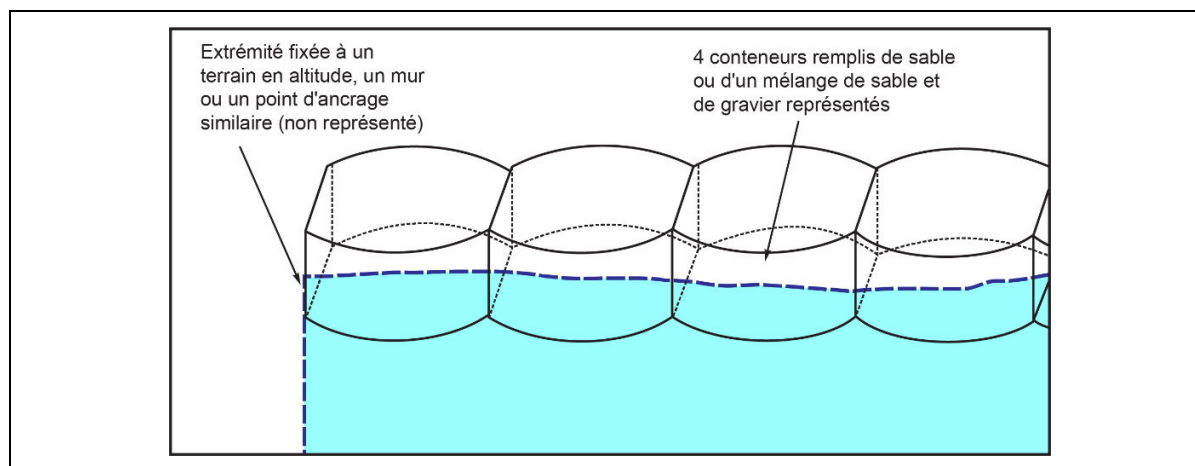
Conteneurs souples remplis de gravier ou de sable
